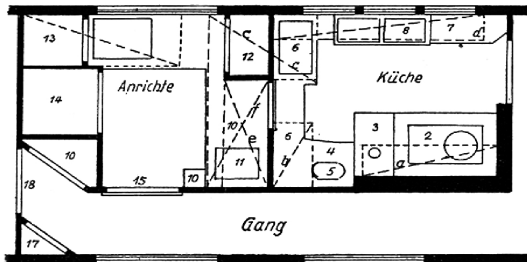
Grundriss der Mitropa-Speisewagenküche
